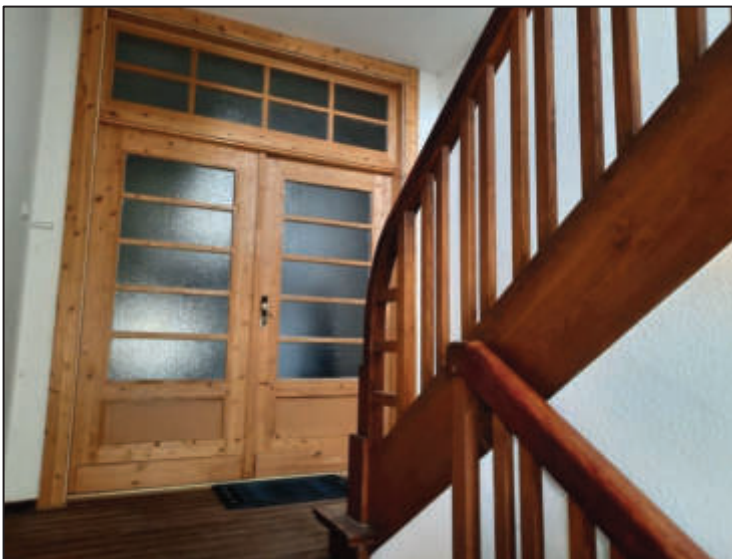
Treppenhaus mit Wohnungseingang Erdgeschoß
